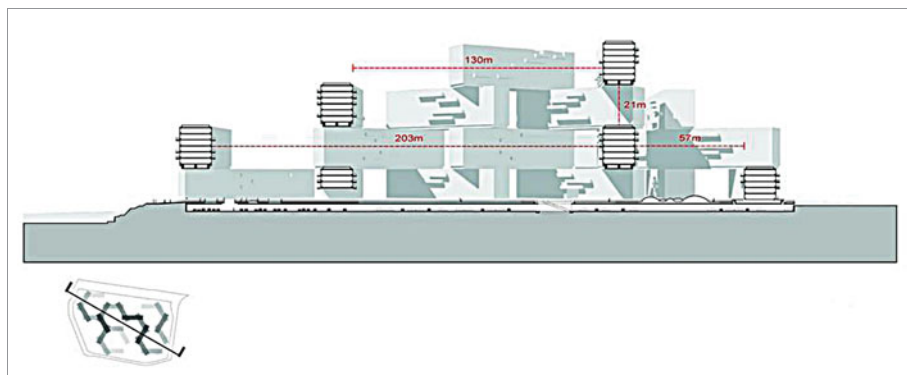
Sezione trasversale dell'intervento. Fonte: <http://www10.aeccafe.com/>. Accesso: 15/02/2016.
